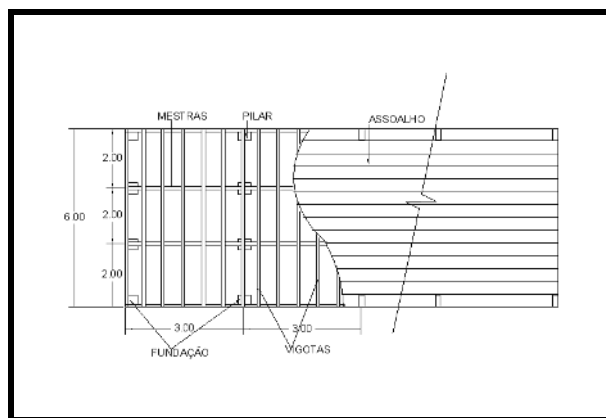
Pavilhão de 6,00 x N metros – planta
